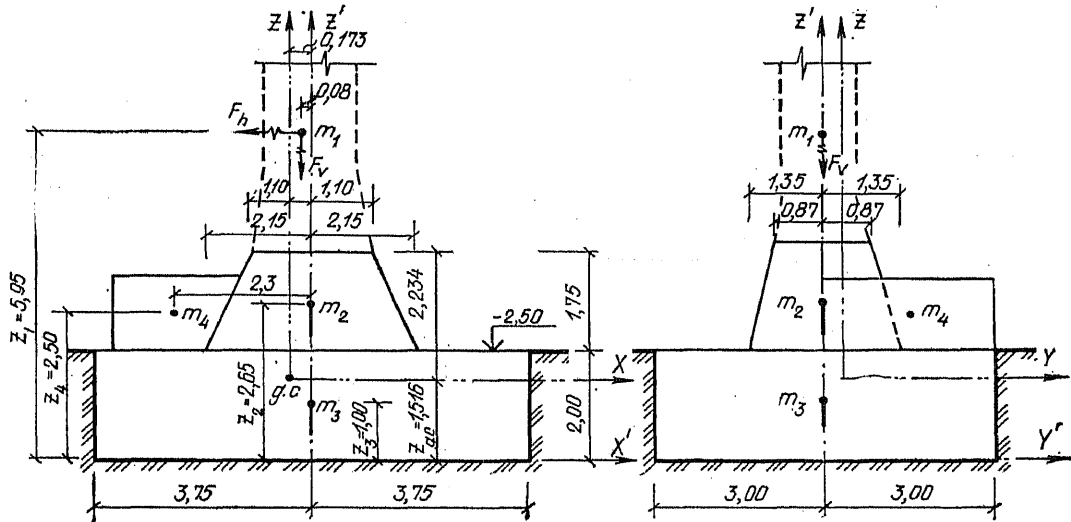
Фундамент лесопильной рамы РД-75/6
